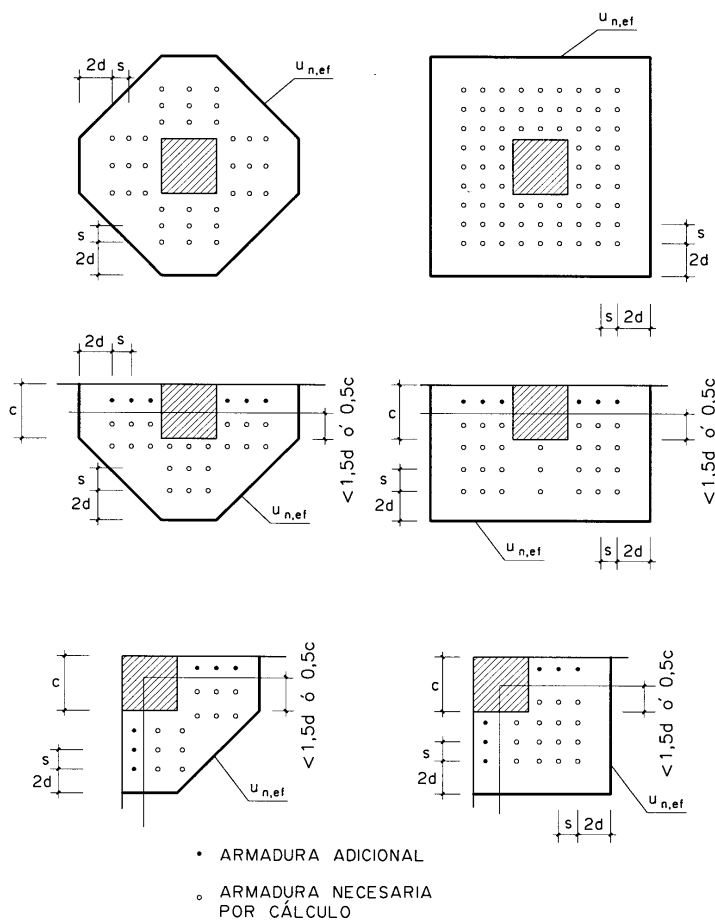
Disposición en planta de la armadura de punzonamiento
